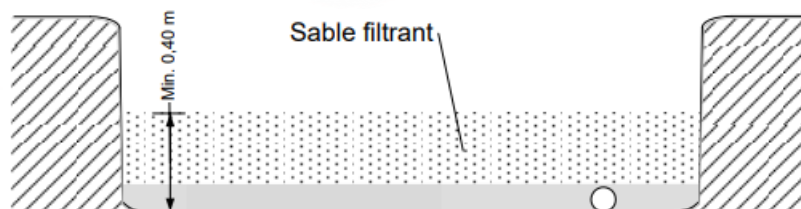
Vue en coupe de l'excavation avec la couche de sable filtrant
